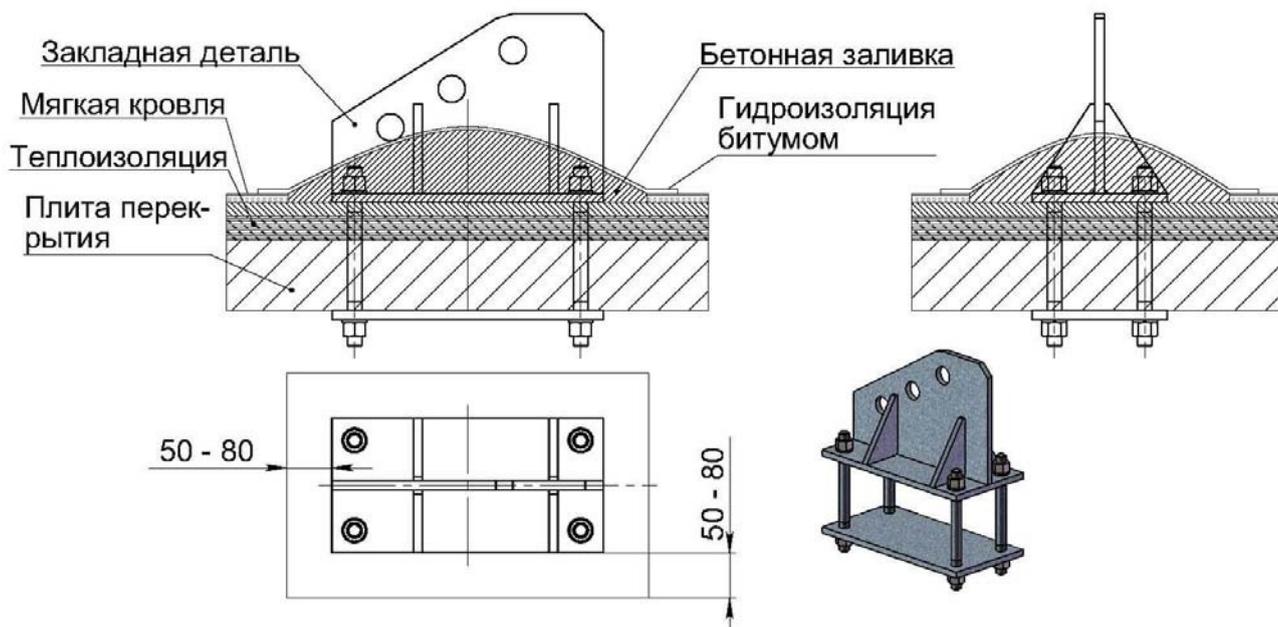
Анкер крепления оттяжек (установка на кровле).
